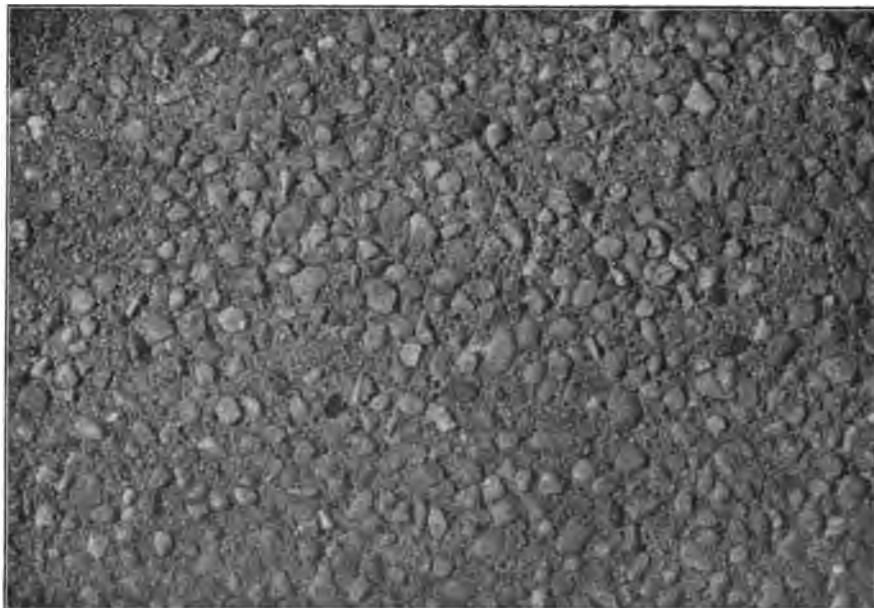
Vorsetzbeton, gewaschen und abgebürstet.
